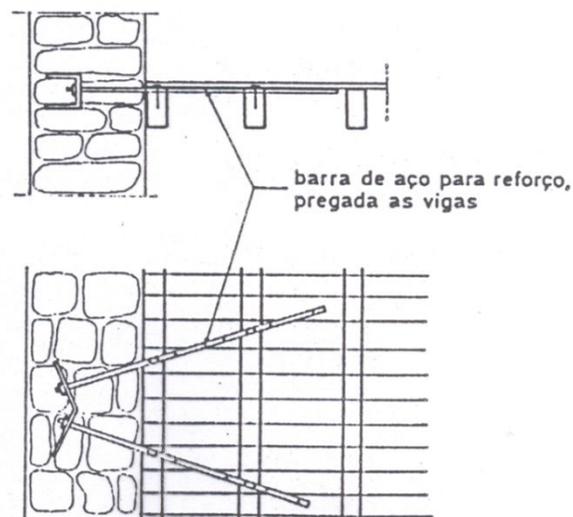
Reforço de ligação entre o pavimento de madeira e as paredes transversais
